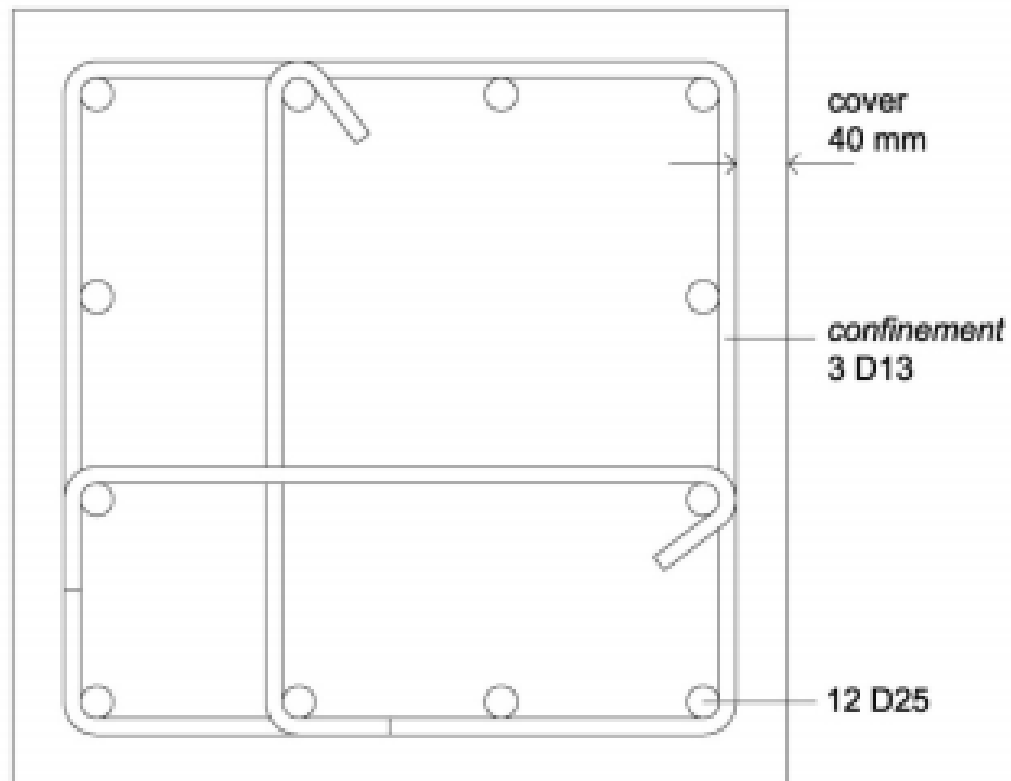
Konfigurasi penulangan sengkang di interior support.
